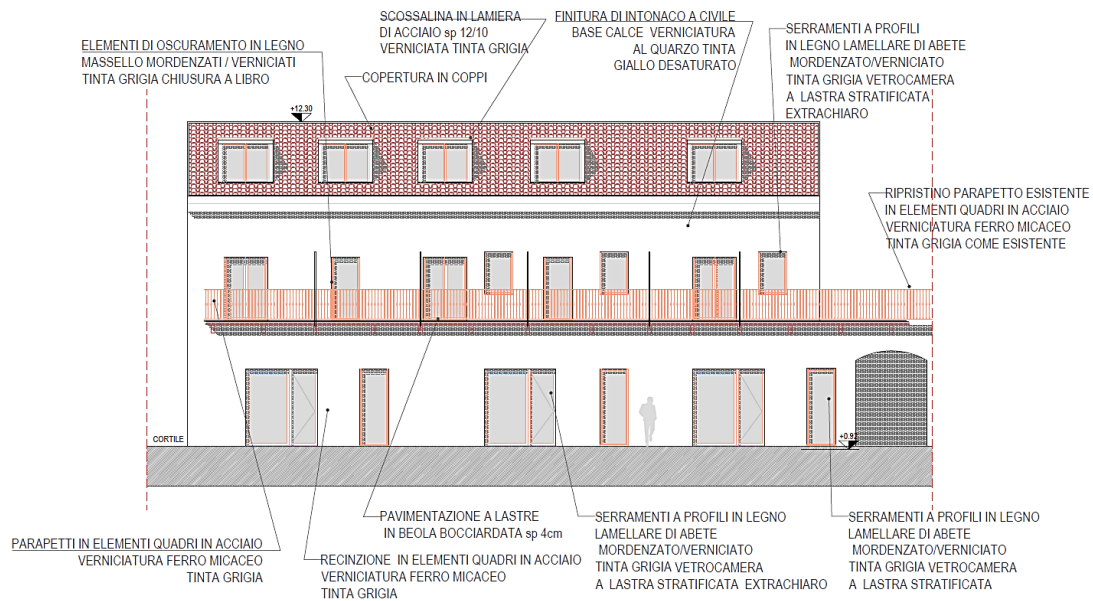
; Prospetto del corpo E con indicazione delle misure di conservazione intraprese.
